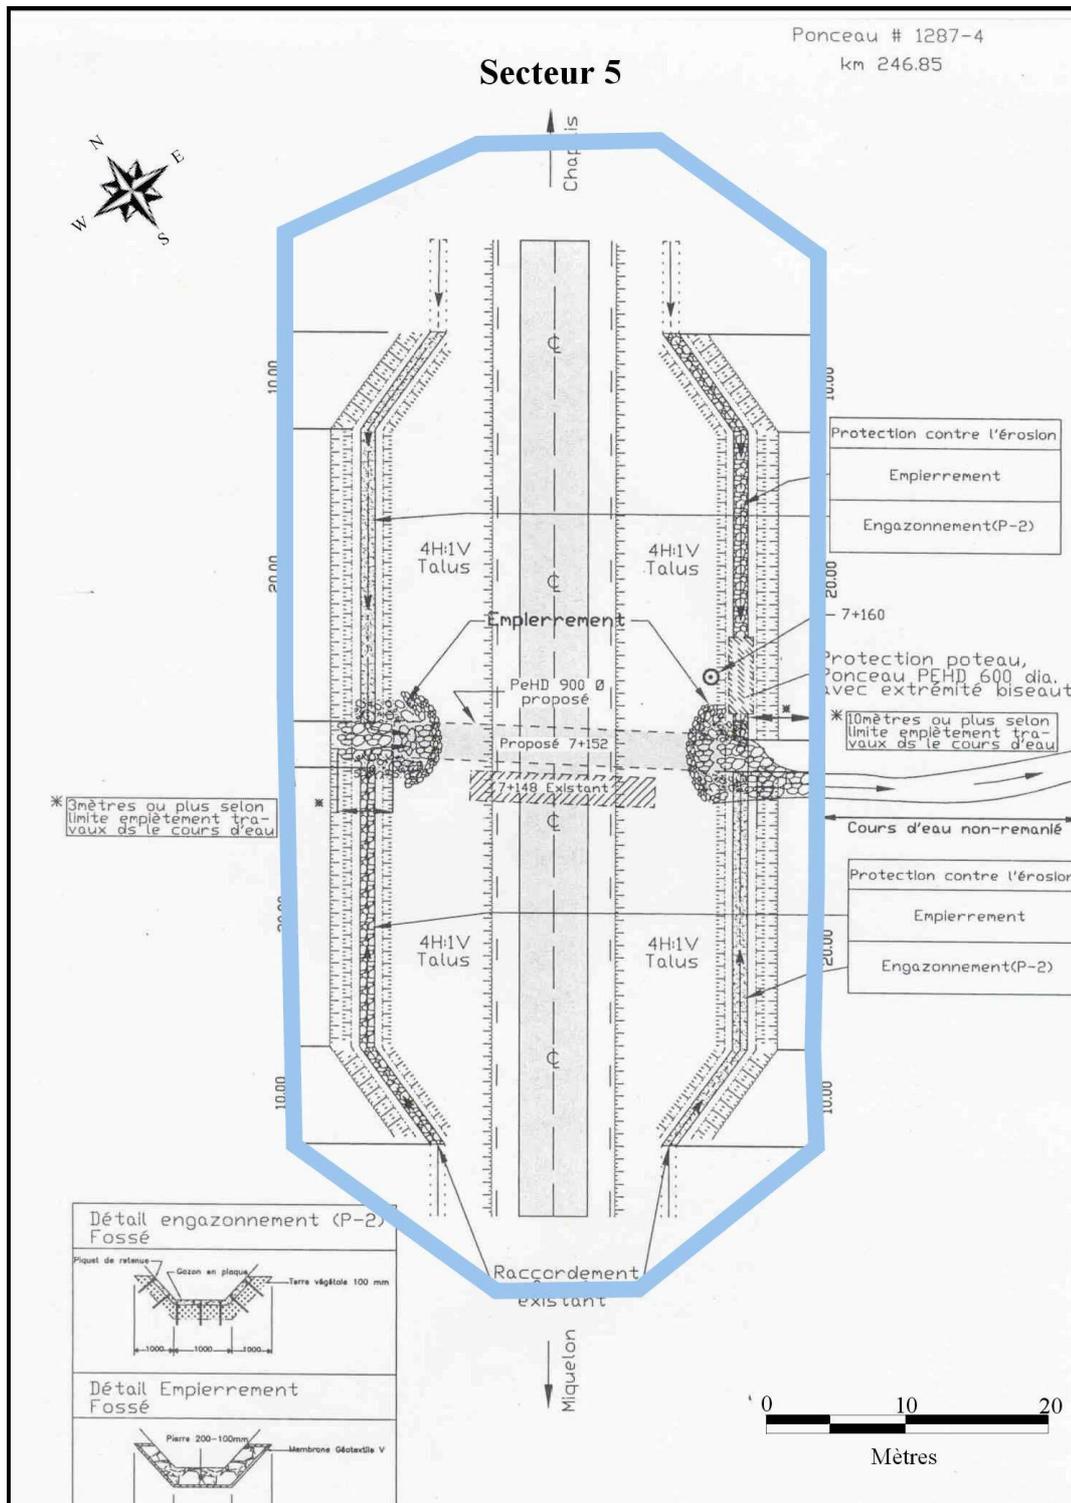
projet 154-07-0858, ponceau #1287-4, plan de construction et secteur d'inventaire.
